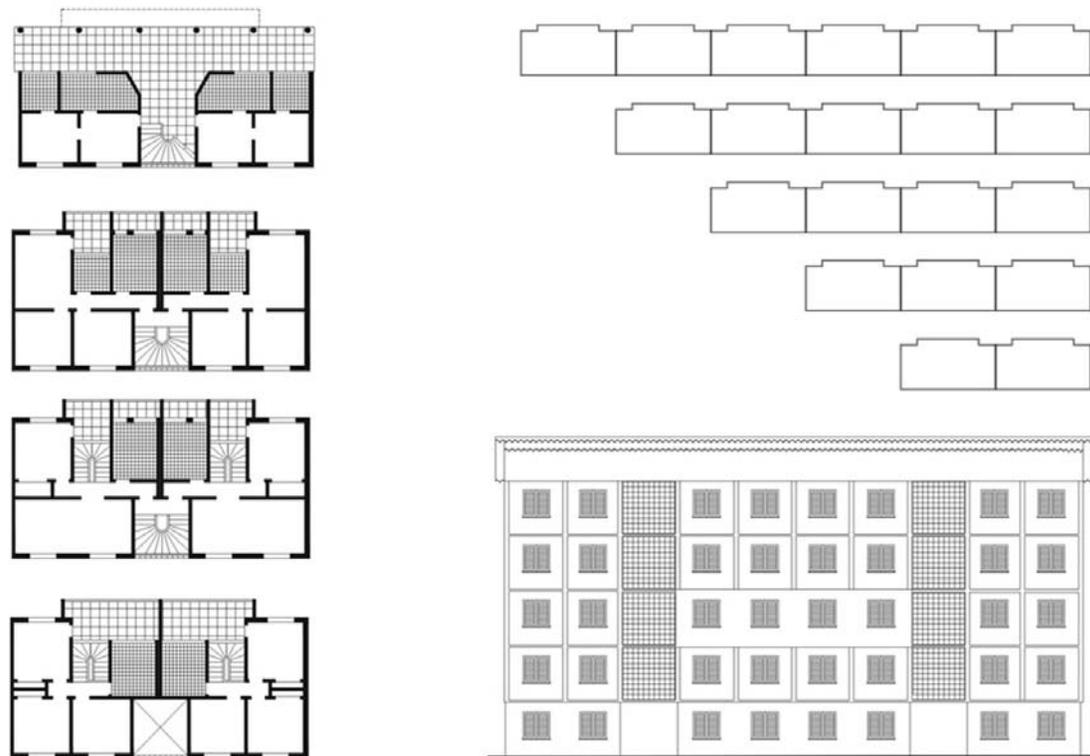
Planta baixa dos pavimentos e fachada do Residencial Mooca
